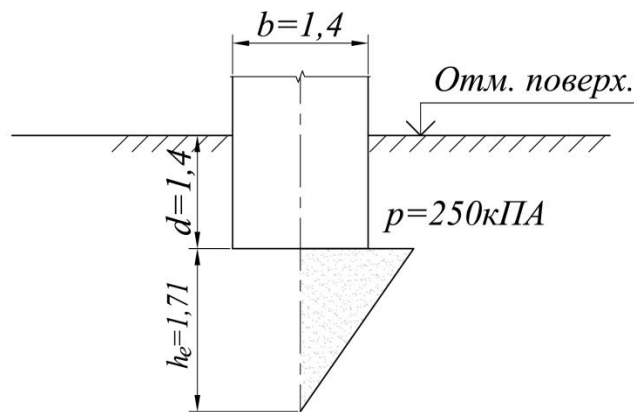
Расчет конечной стабилизированной осадки фундамента методом эквивалентного слоя
